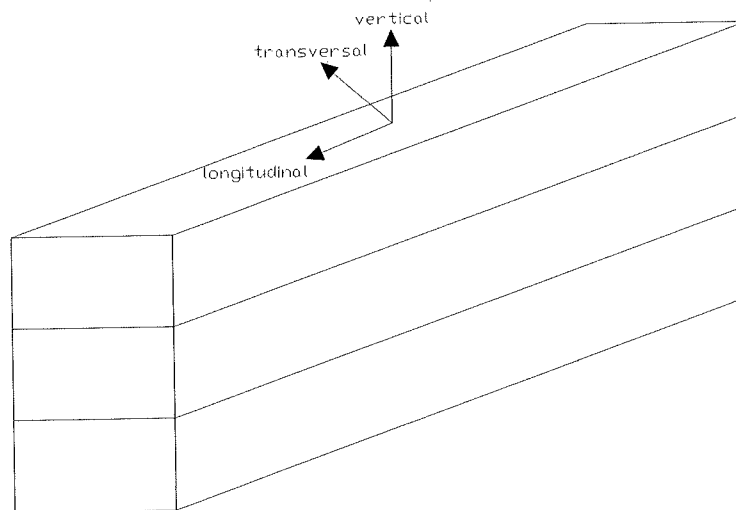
Colocación de sensores en azotea y firme, en tres direcciones.
